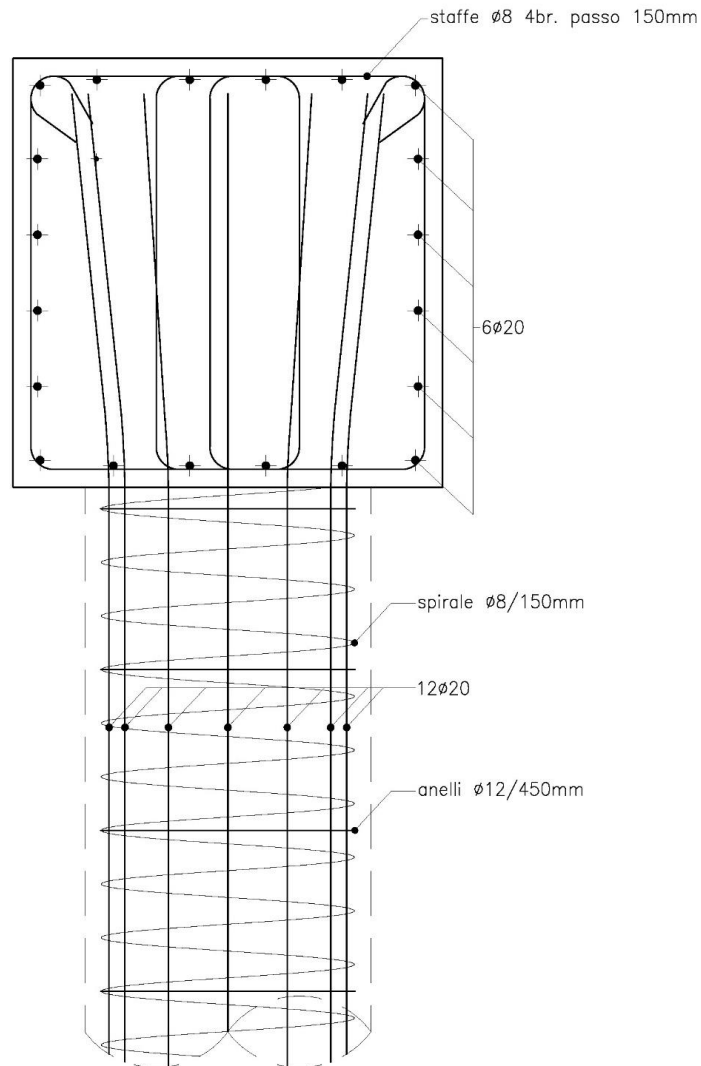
Vista delle armature principali della pila – spalla su tre pali
